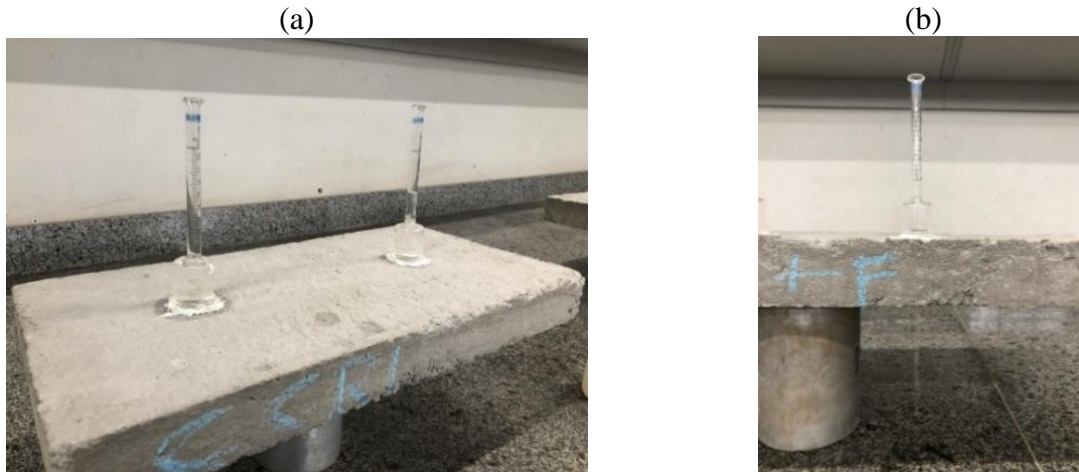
Tubos de Karsten fixados nos painéis: (a) Tubo em painel sem fissura, (b) Tubo em painel com fissura.
